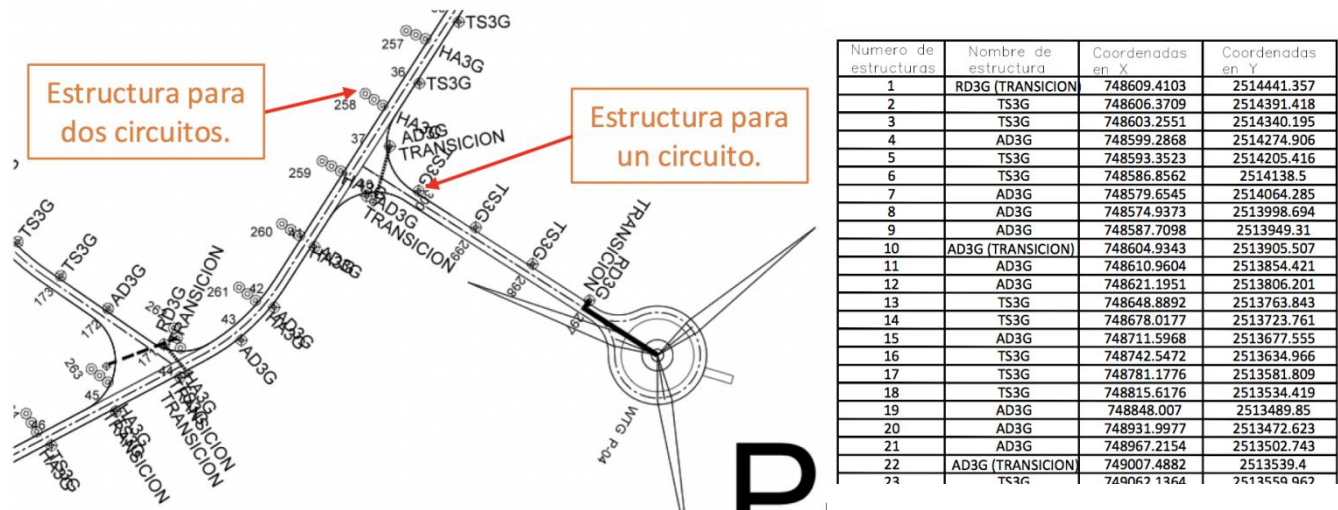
Distribución de estructuras en planos de planta y coordenadas de ubicación de estructuras, Planos de planta circuitos, ver planos de planta en Anexo 4.
